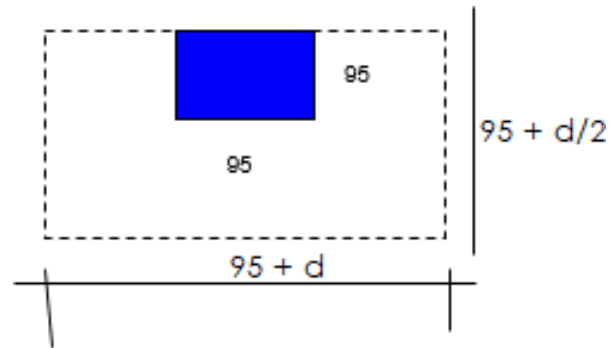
Columnas 2-3-4-5-26-27-28-29
